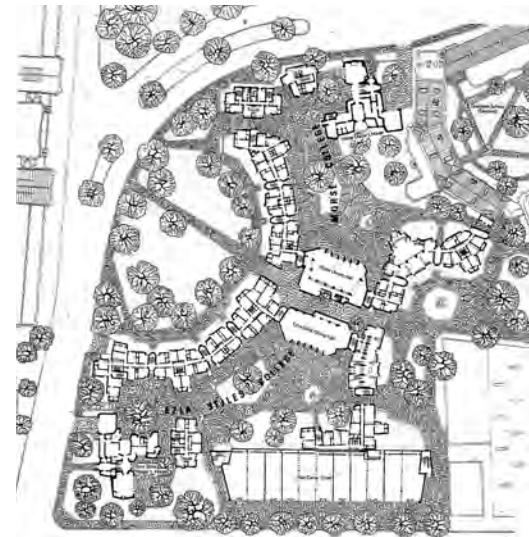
エズラ・モース・カレッジ | 全体配置図 / 1階平面図
